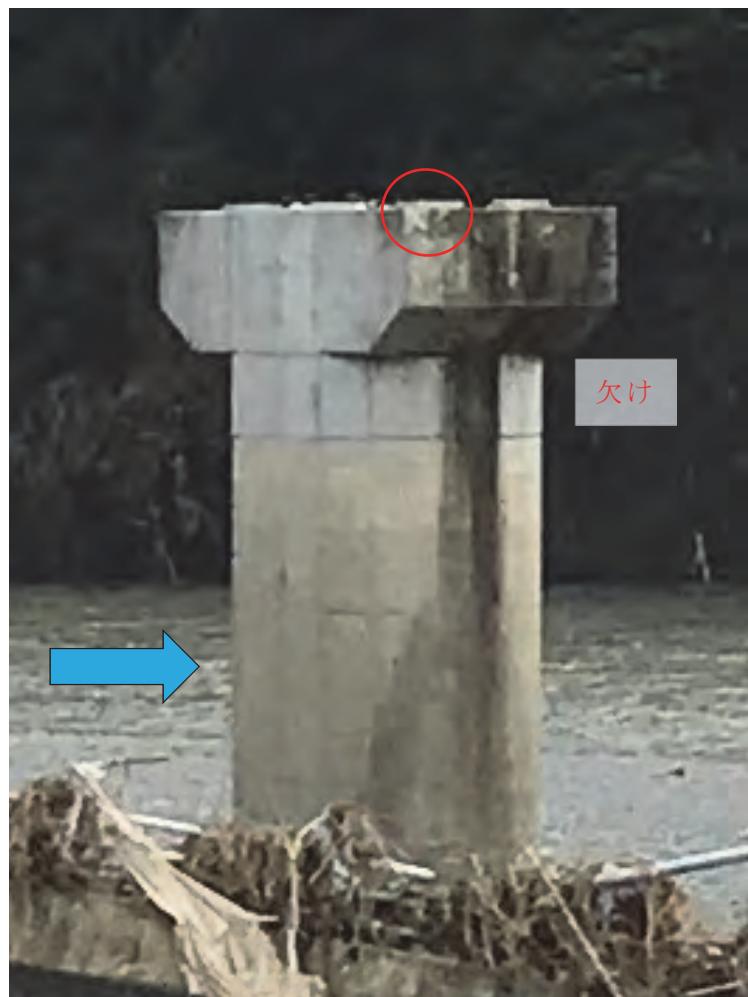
梁部の欠け (P1) (下流側から臨む)
